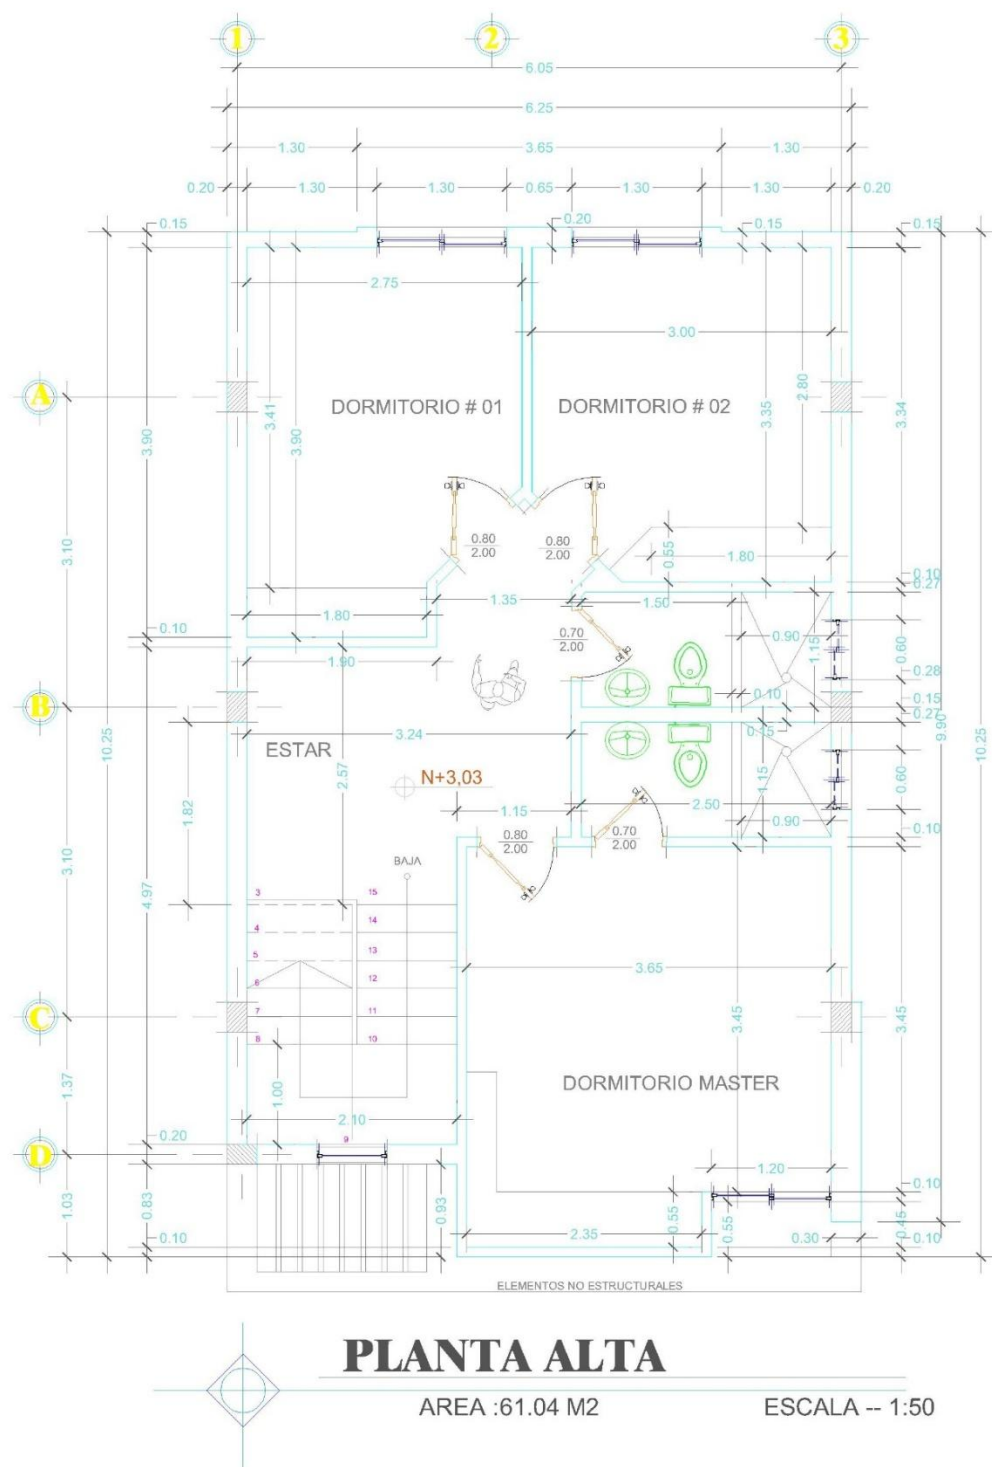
Planos arquitectónicos vivienda de hormigón armadoNota. Proporcionado por arquitecto de la vivienda.
